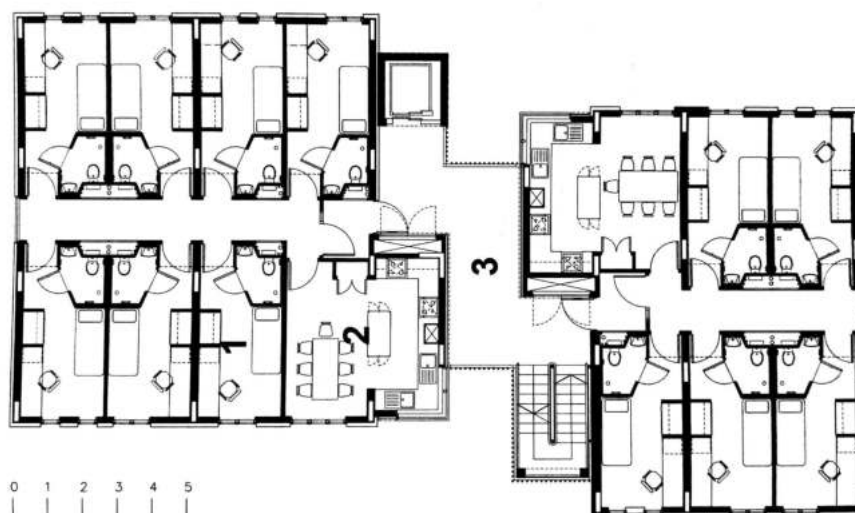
Planta do Pavimento Tipo. Alliance Student Housing, Reino Unido
